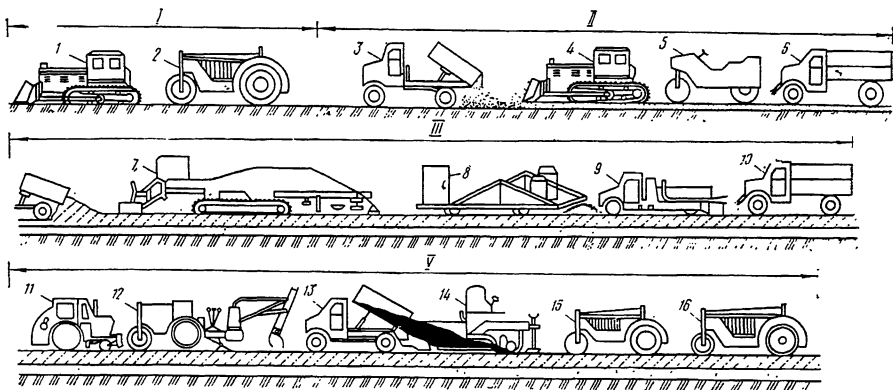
Технологическая схема поточного строительства проезжей части городской улицы с асфальтобетонным покрытием на бетонном основании
